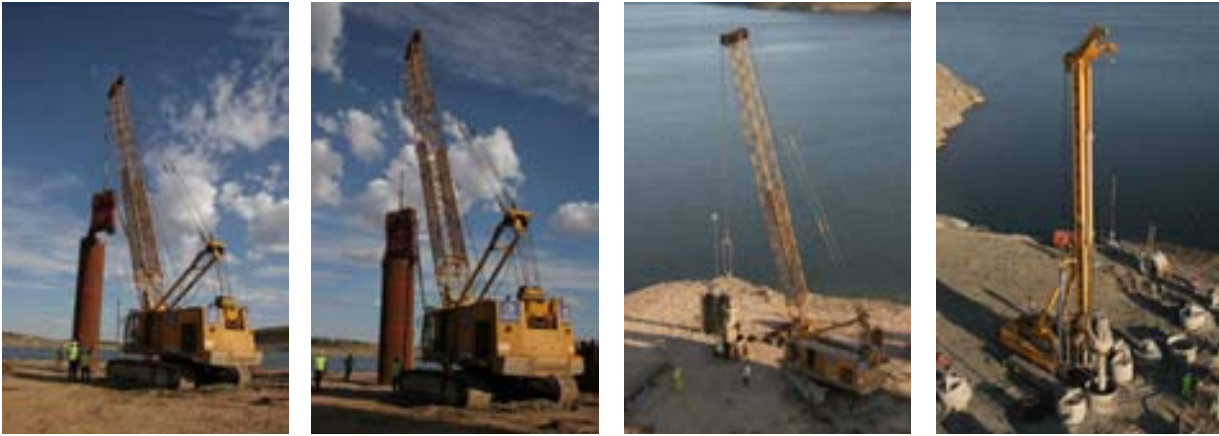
Secuencia de hincado de la primera camisa de chapa en península 1, y excavación en península 2
